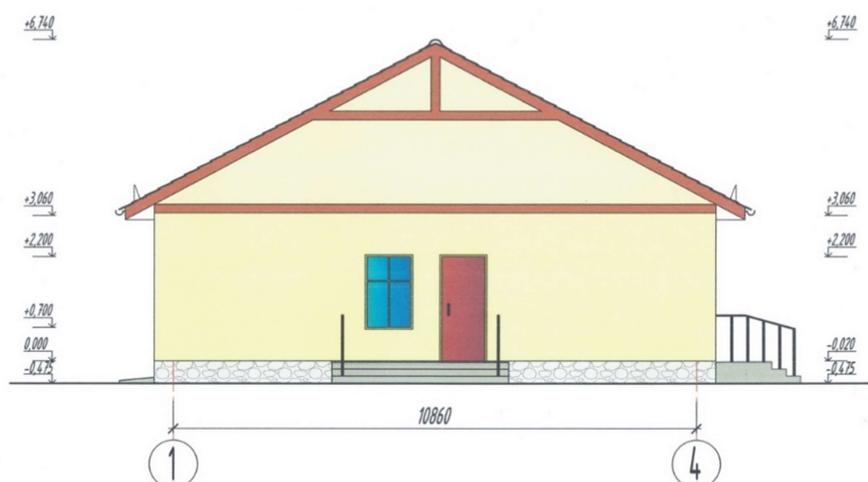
Фасад здания многоквартирного жилого дома в осях 1-4
